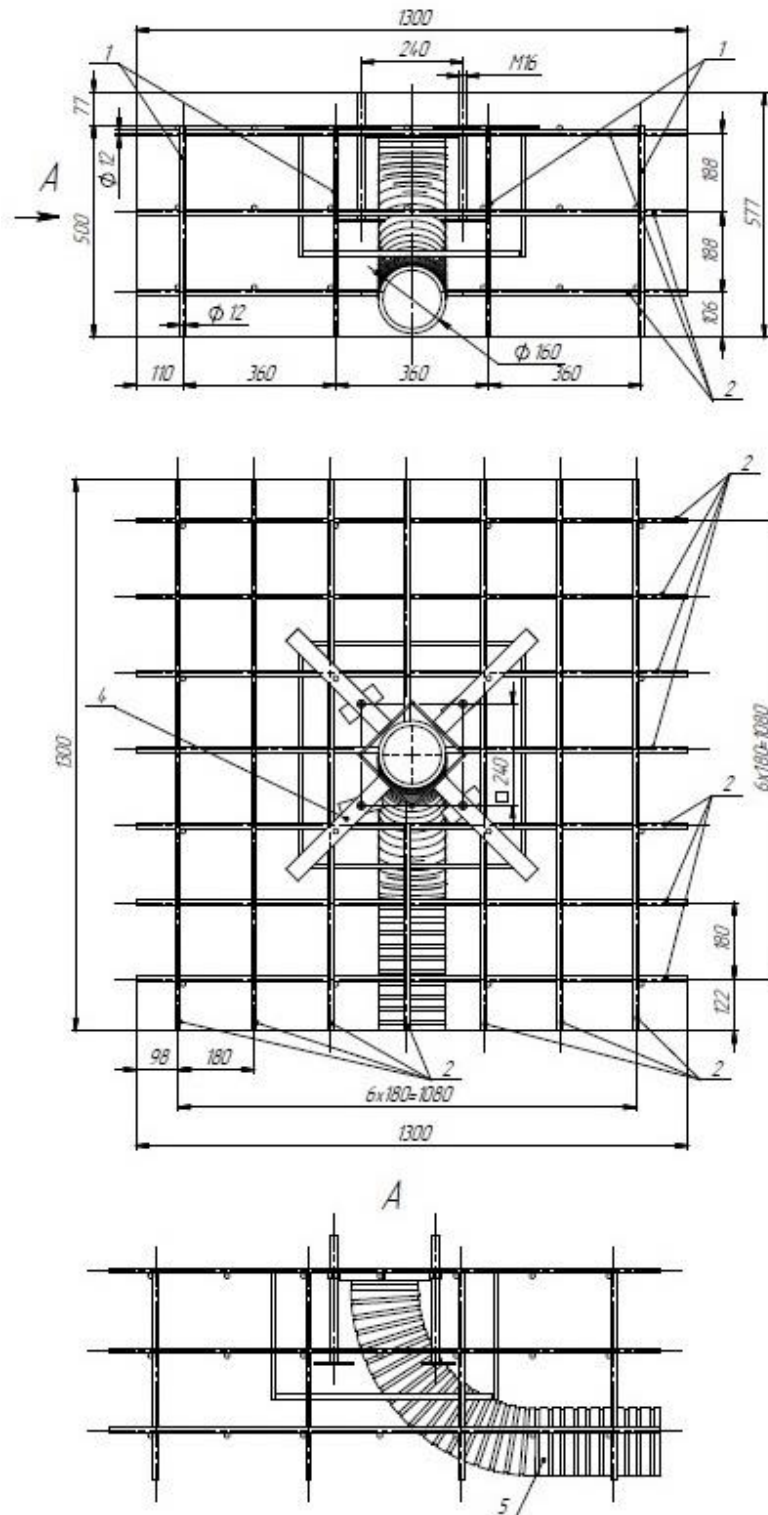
Схеми з розмірами армування та складових бетонної основи
